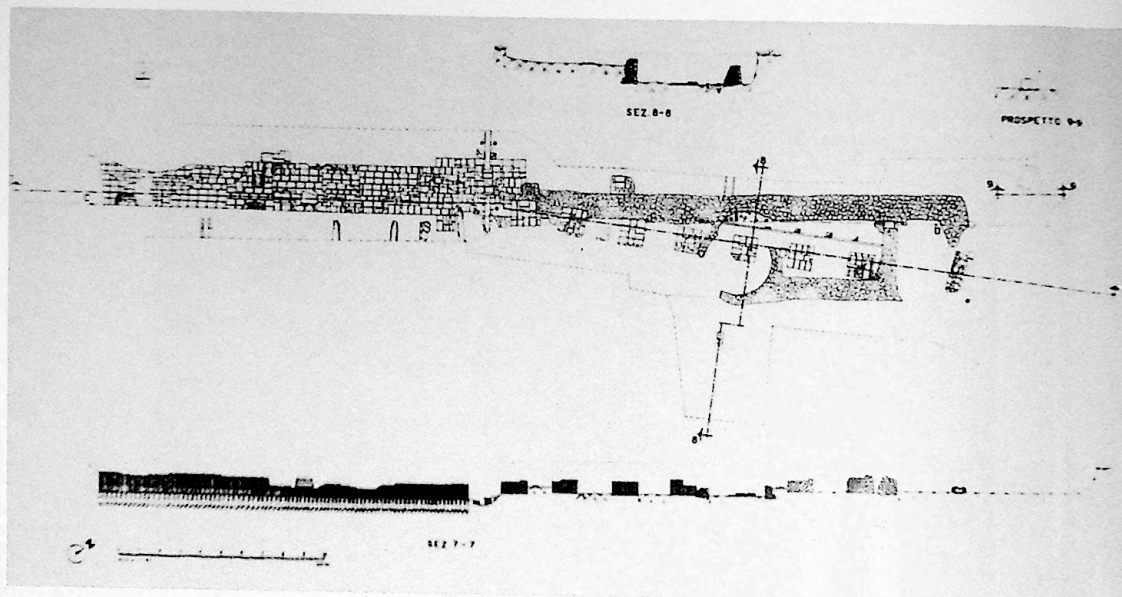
Planimetria del muro e del porticato settentrionali.
